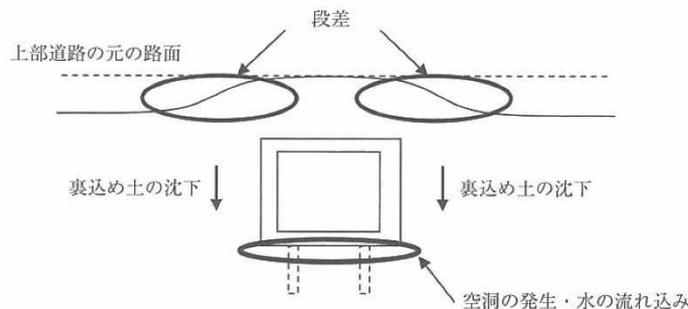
カルバート前後区間での段差¹⁰⁾
